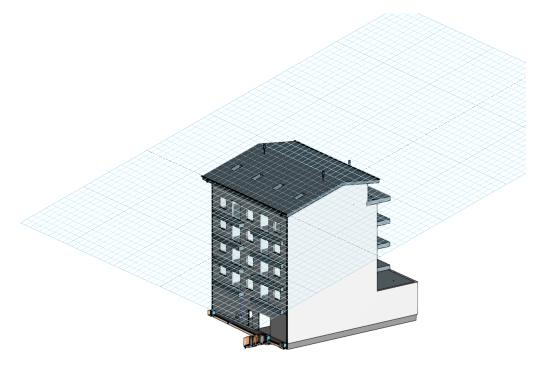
Plano de trabajo generado a partir de un plano genérico
